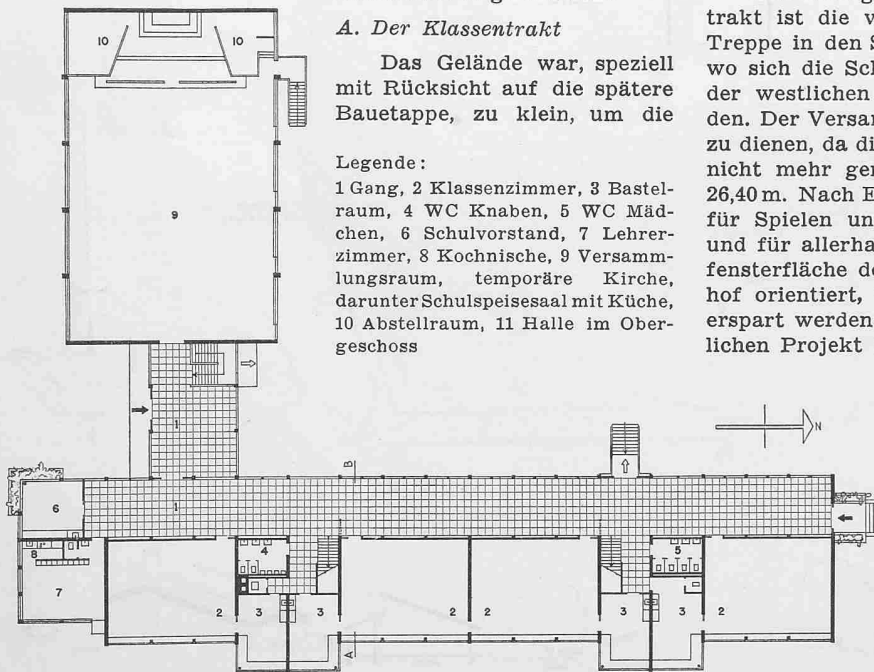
Erdgeschossgrundriss, Masstab 1: 600
